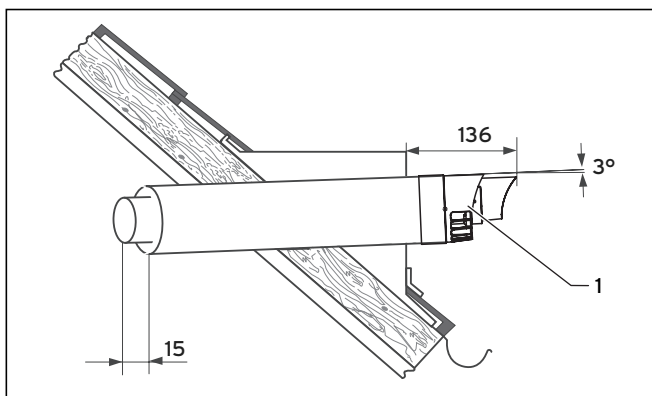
Einbau der waagerechten Dachdurchführung
